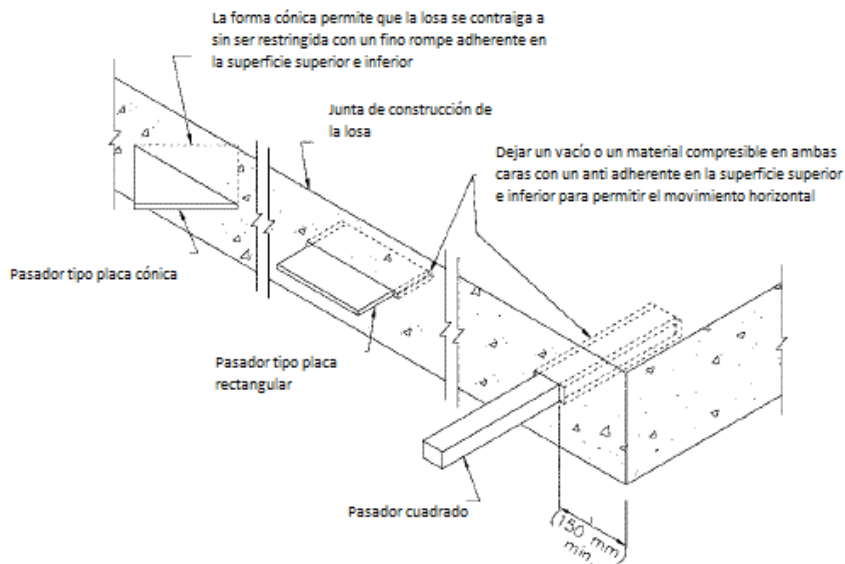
Vista isométrica que indica las disposiciones para el movimiento longitudinal en las juntas de construcción con pasadores (ACI 360, 2016)
